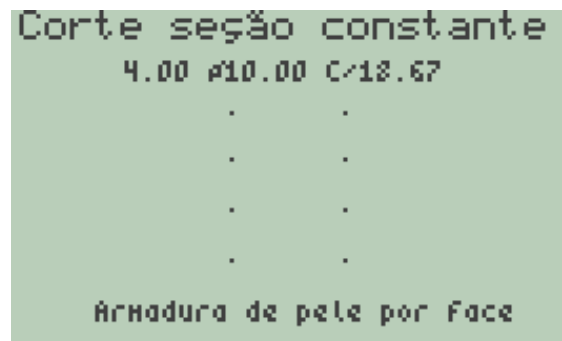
Viga alavanca - Detalhamento da armadura de pele.
